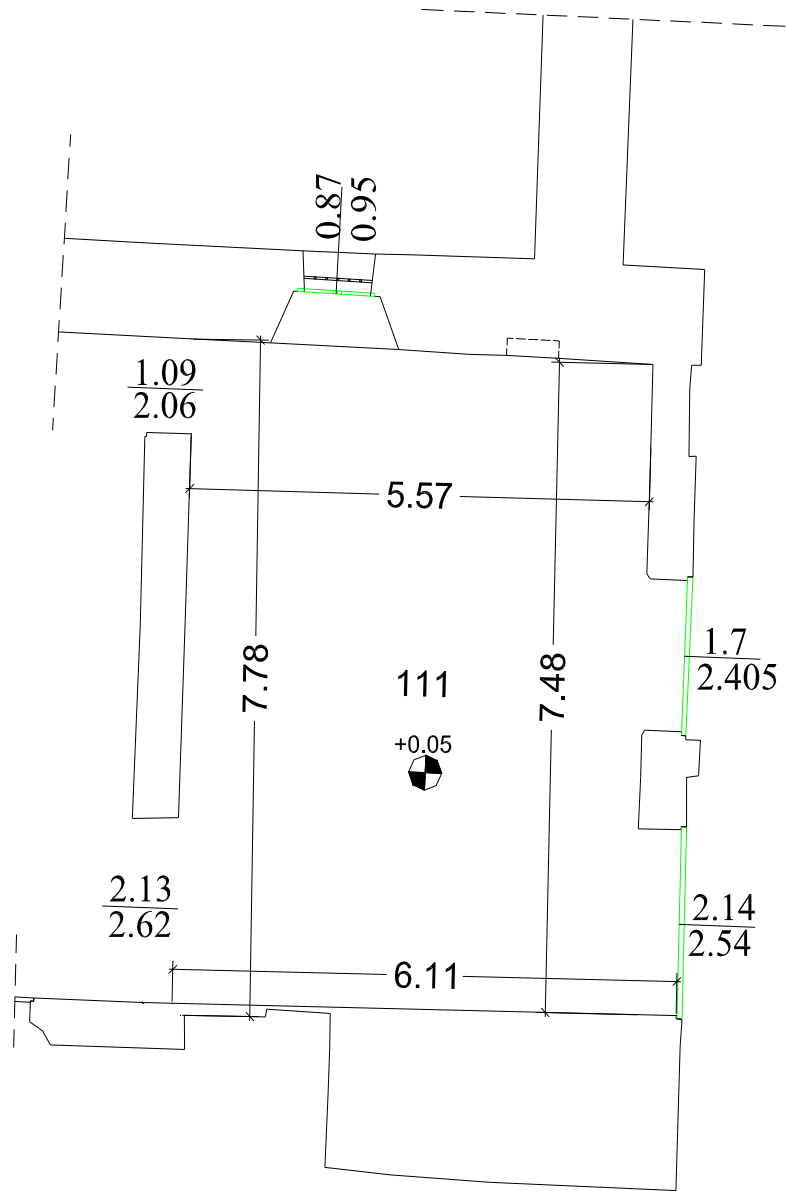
Individuazione aperture nel vano 111 al piano terra
